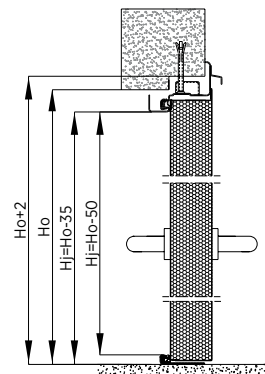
Pose au mur – bloc-porte à deux vantaux, bâti angulaire sans rupture de pont thermique – coupe verticale
